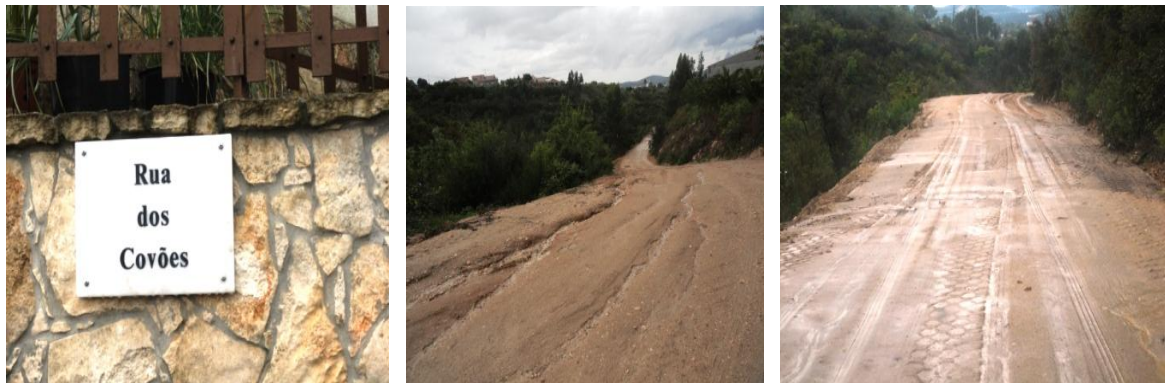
Identificação da rua e pavimento com deformação na camada inferior.
